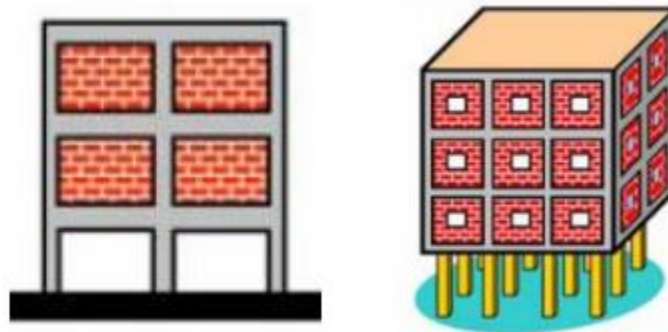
Ejemplos de planta baja débil (Astorga y Rivero, 2009).
